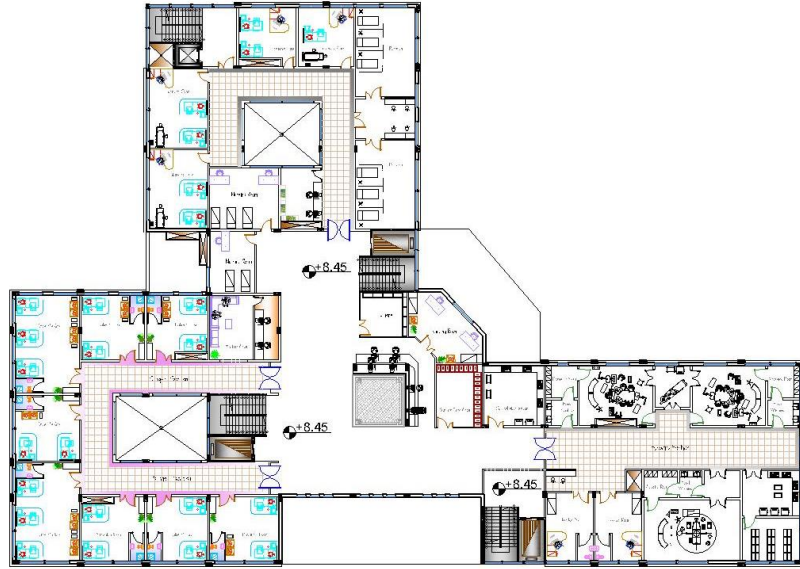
المسقط الأفقي للطابق الأرضي
